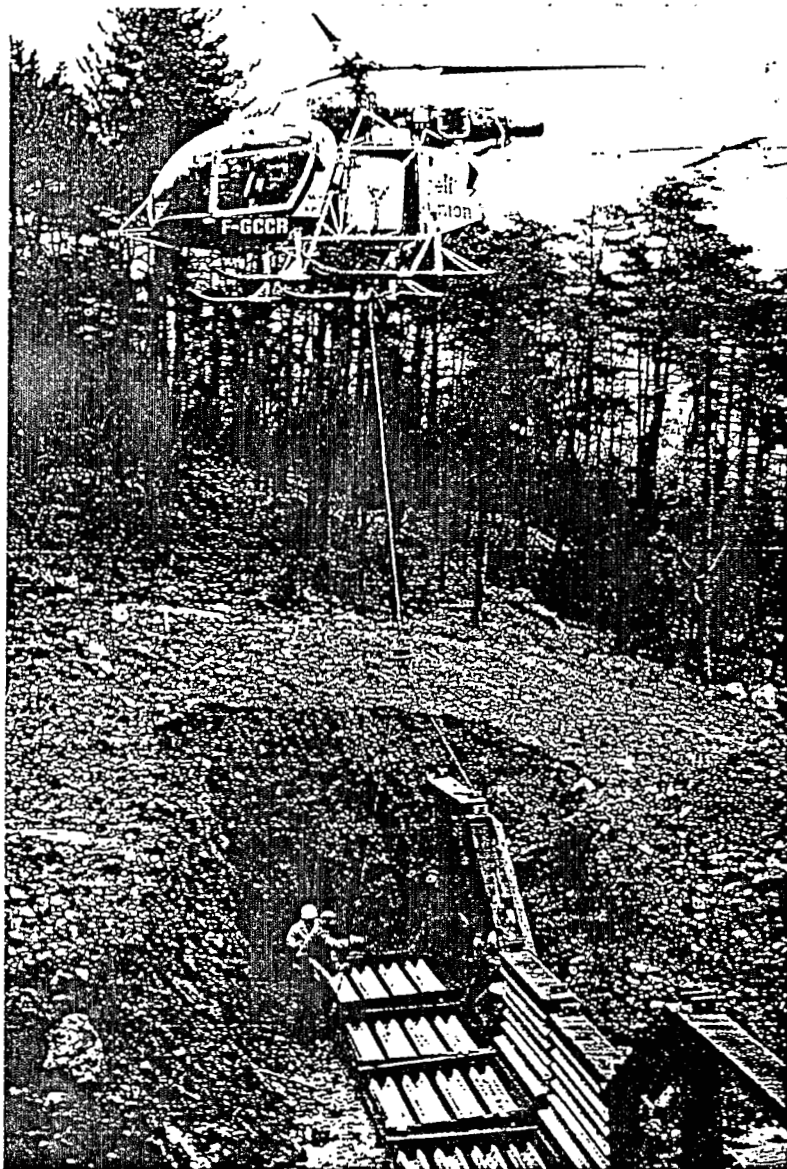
Montage d'un barrage métallique en éléments préfabriqués
